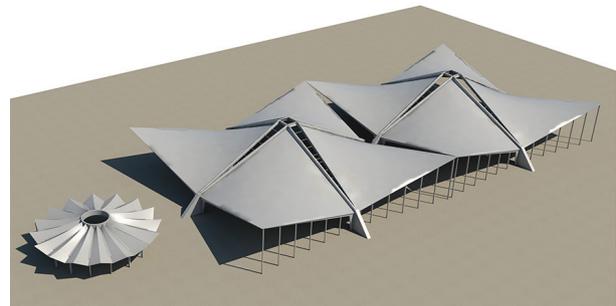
Imagen tridimensional del mercado Cristóbal Colón, 1960.
